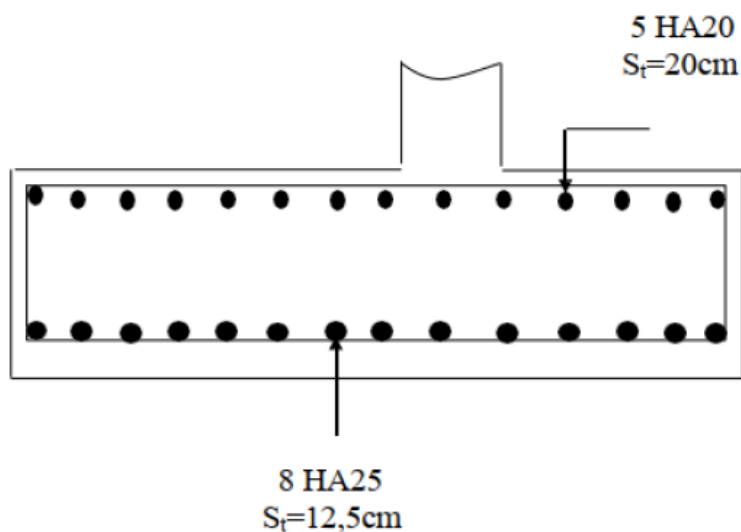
Schéma de ferrailage de la semelle sous culée
